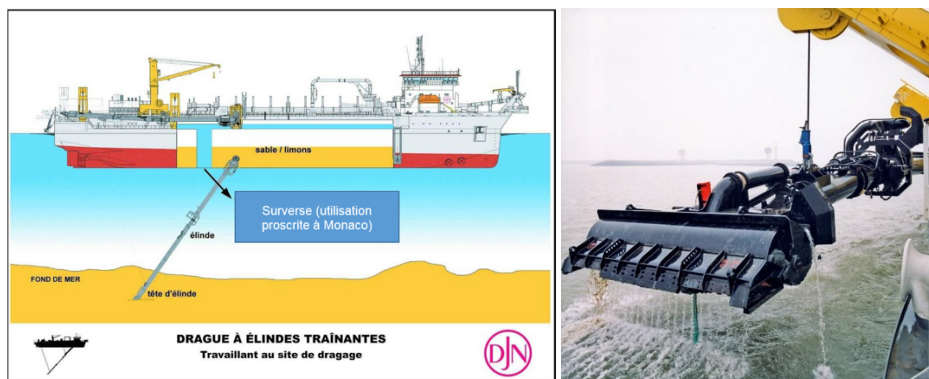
Principe de drague à élinde – Drague Francis Beaufort en opération à Monaco [22].
